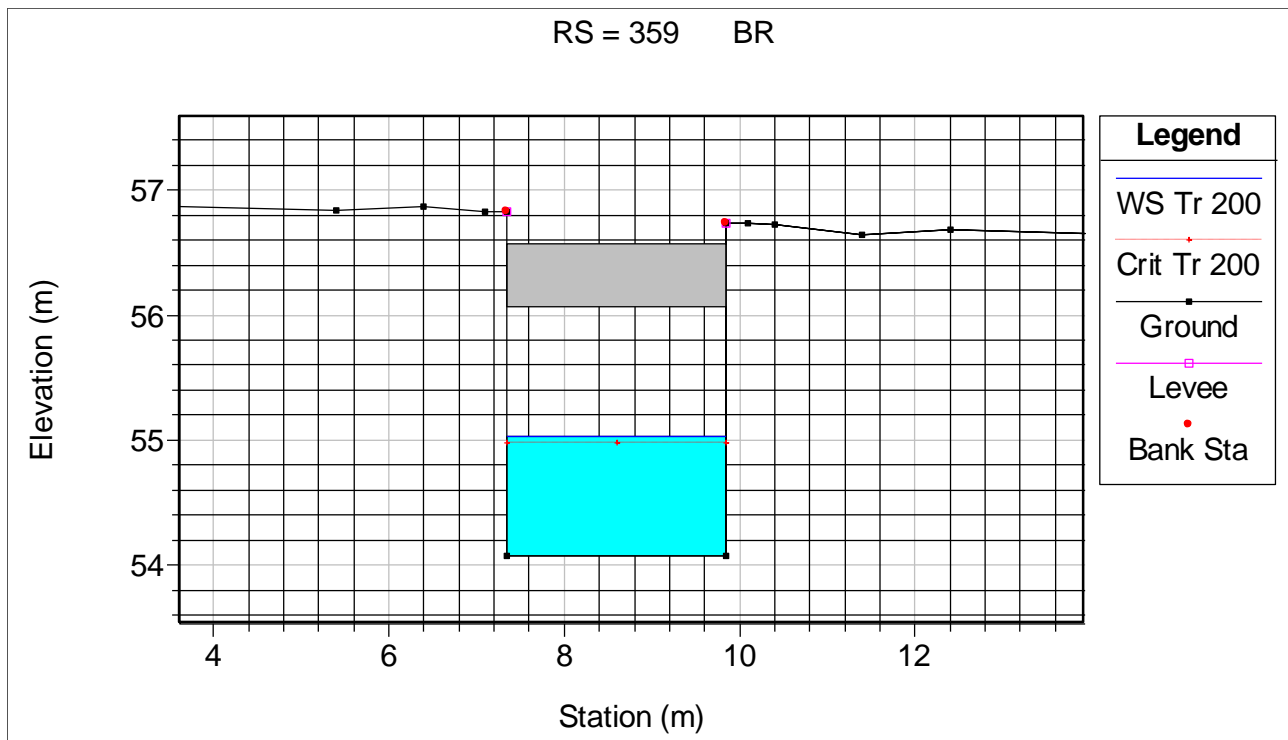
Sezione di HEC-RAS in corrispondenza dell'attraversamento 3
